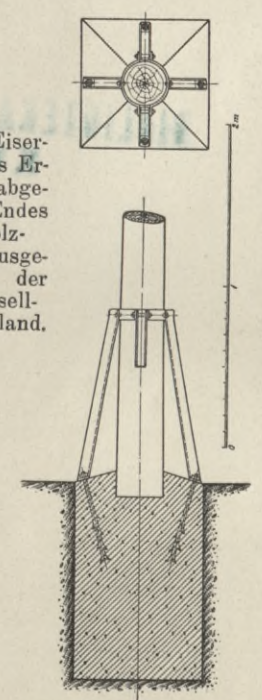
Eiserner Schuh eines Eckmastes aus Holz (Bauart Ganz & Co.) m. Betonfundament.
